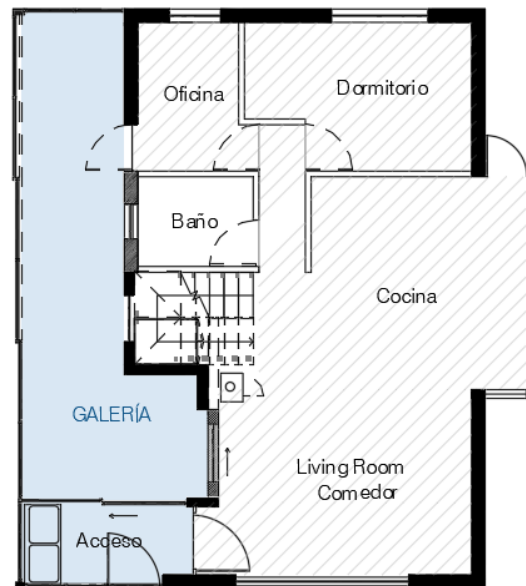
Configuración en planta Fuente: Elaboración Propia.
